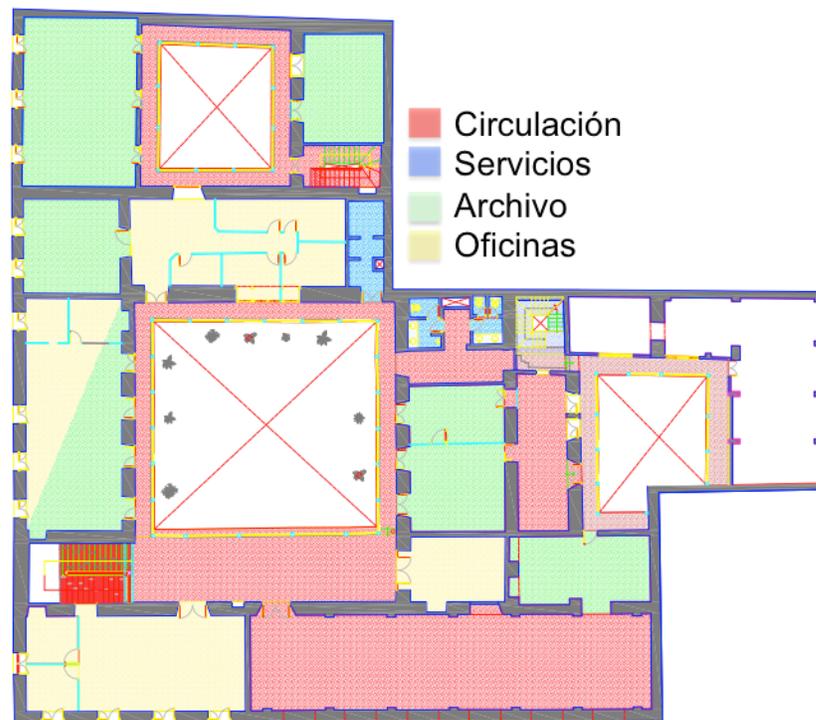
Plano de Uso Actual Planta Segundo Nivel. MGC 2014
